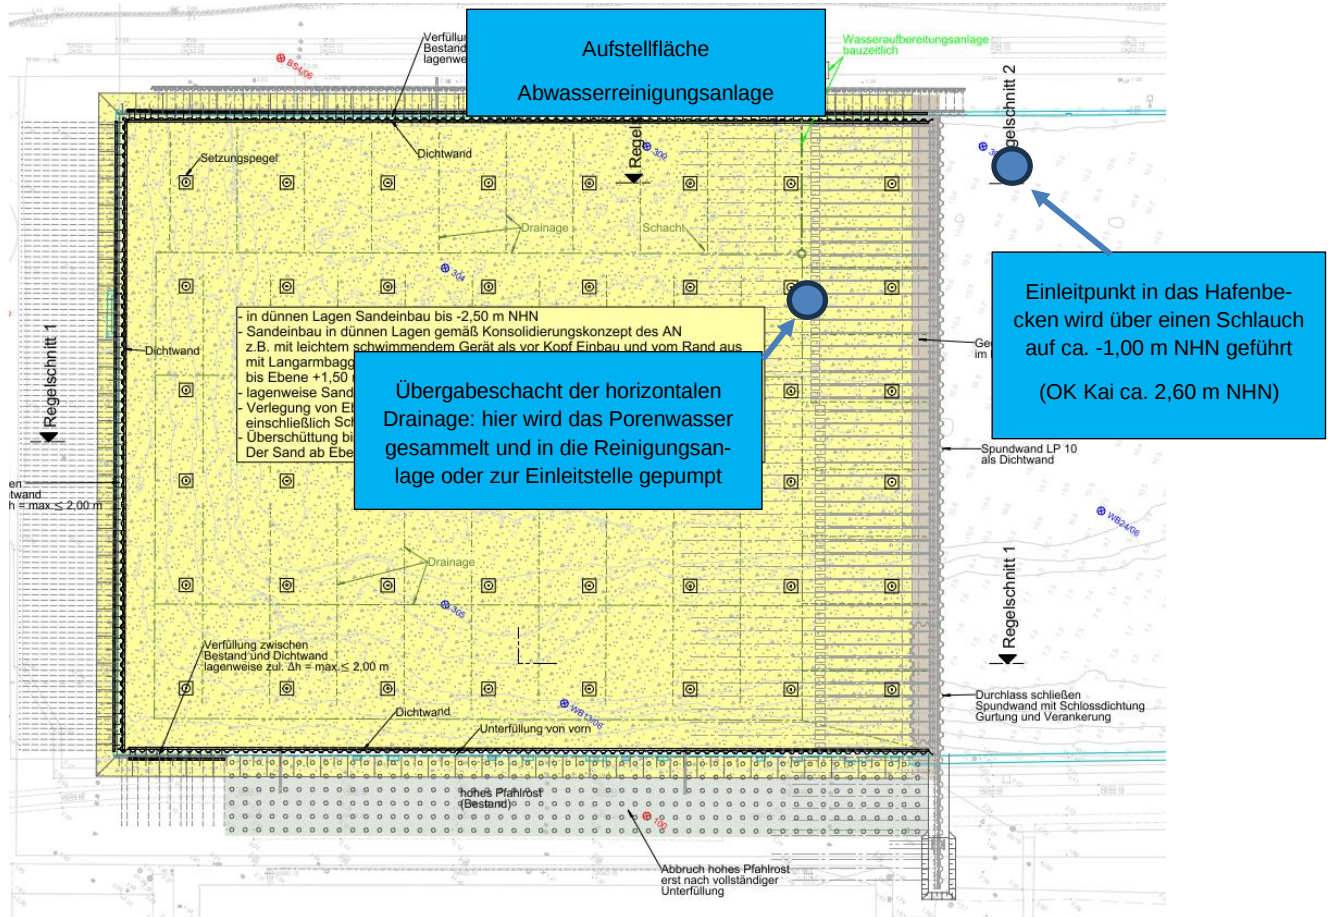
Übergabeschacht Porenwasser, Wasserreinigungsanlage und Einleitstelle
